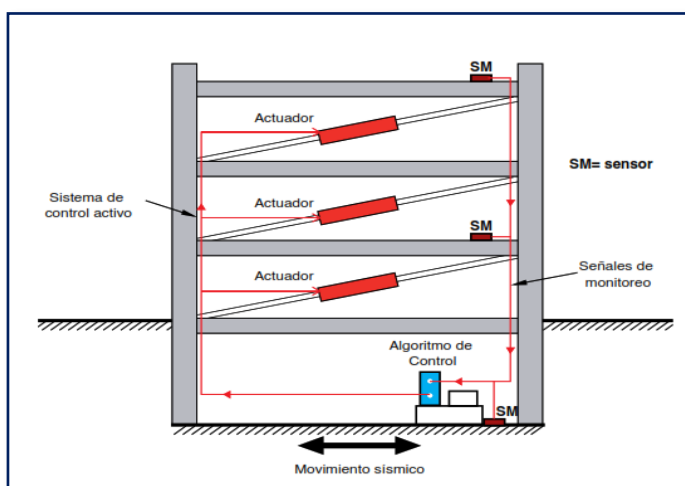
Esquema de Estructura con Sistema de Control Activo
